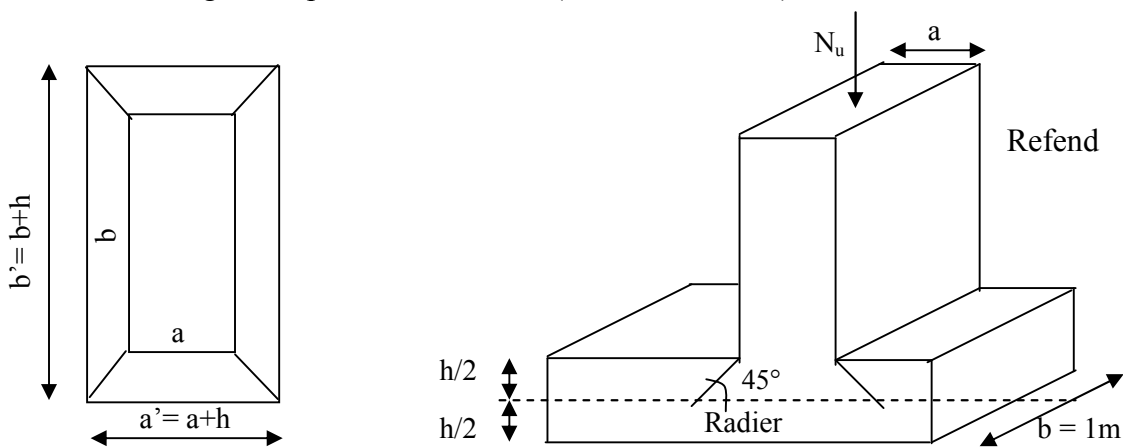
Périmètre utile des voiles et des poteaux.
